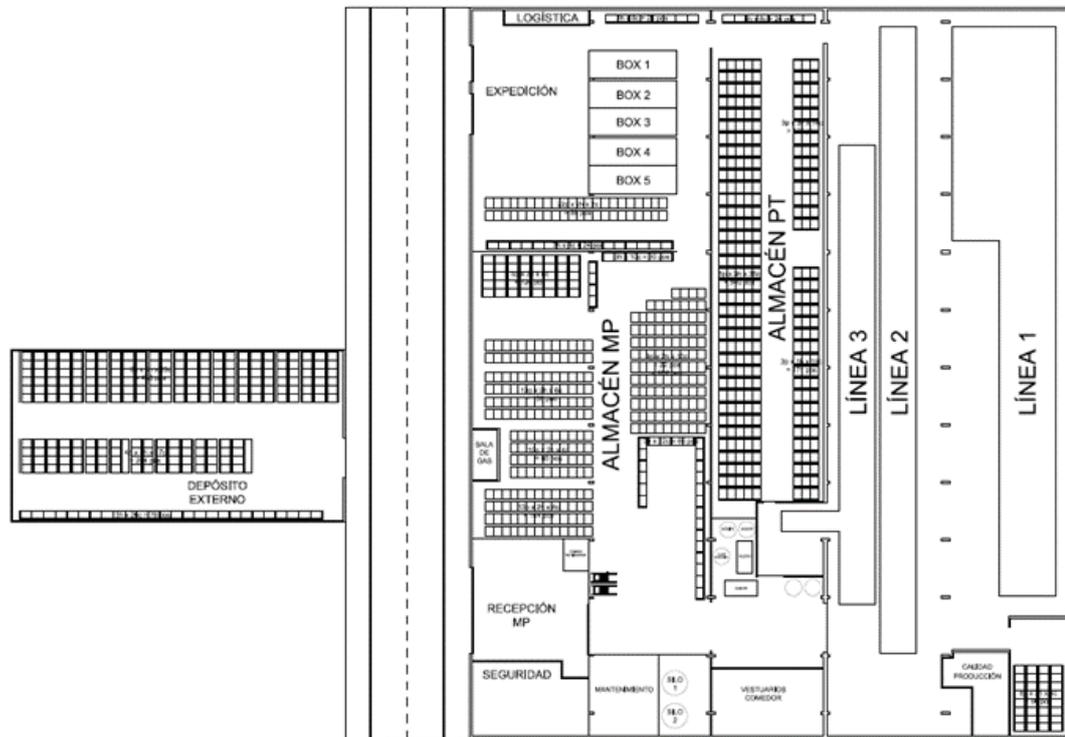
Layout planta con depósito externo. Fuente: Elaboración propia.
